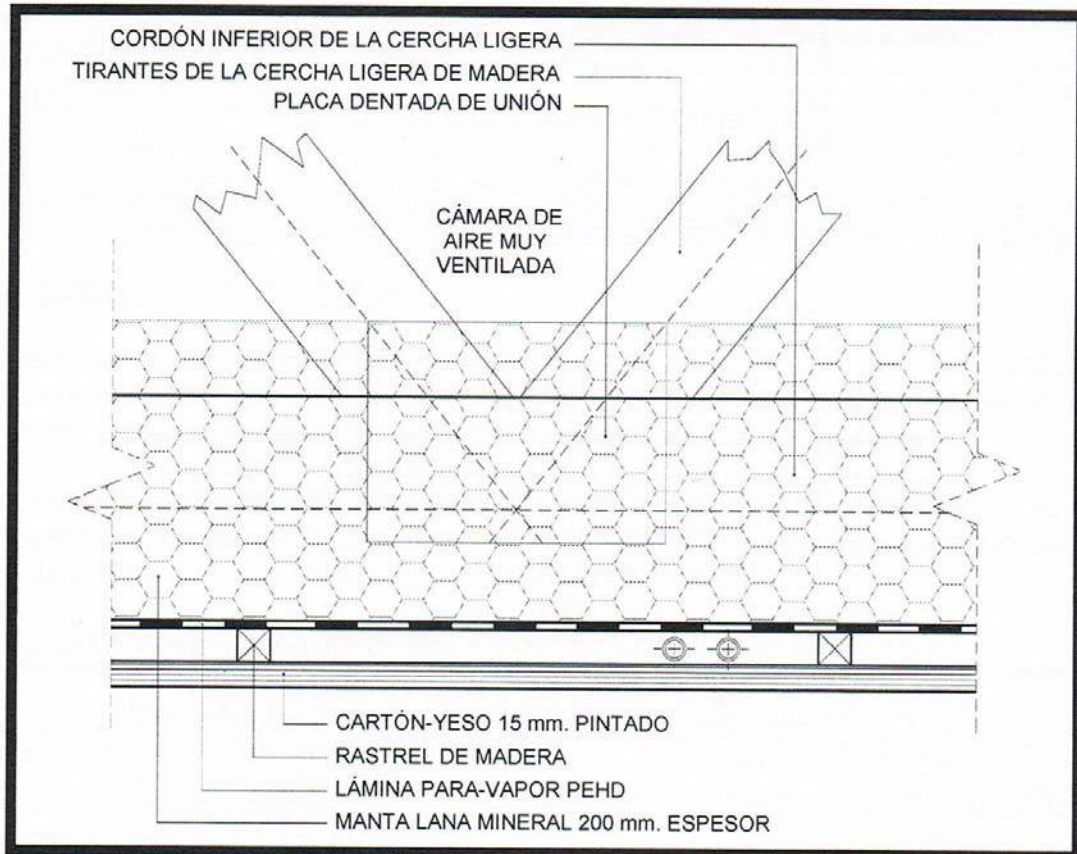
Cordón inferior de la cubierta ligera. Cubierta tipo de la envolvente (C1)
